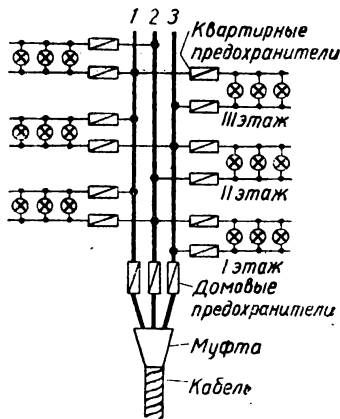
Схема осветительной сети жилого дома при соединении фаз нагрузки треугольником.
